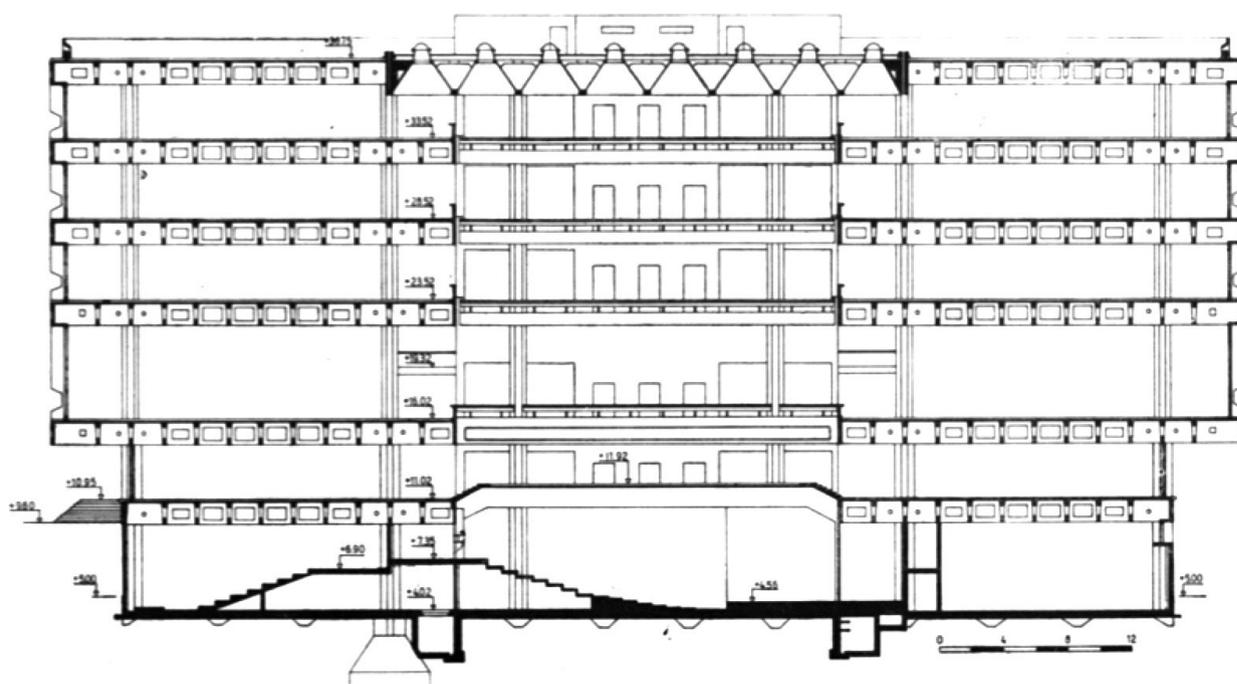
| Corte do pavilhão 2, com cobertura do pátio central diferente da do pavilhão 3. Fonte: revista *Summa*, Nº19, outubro de 1969.
